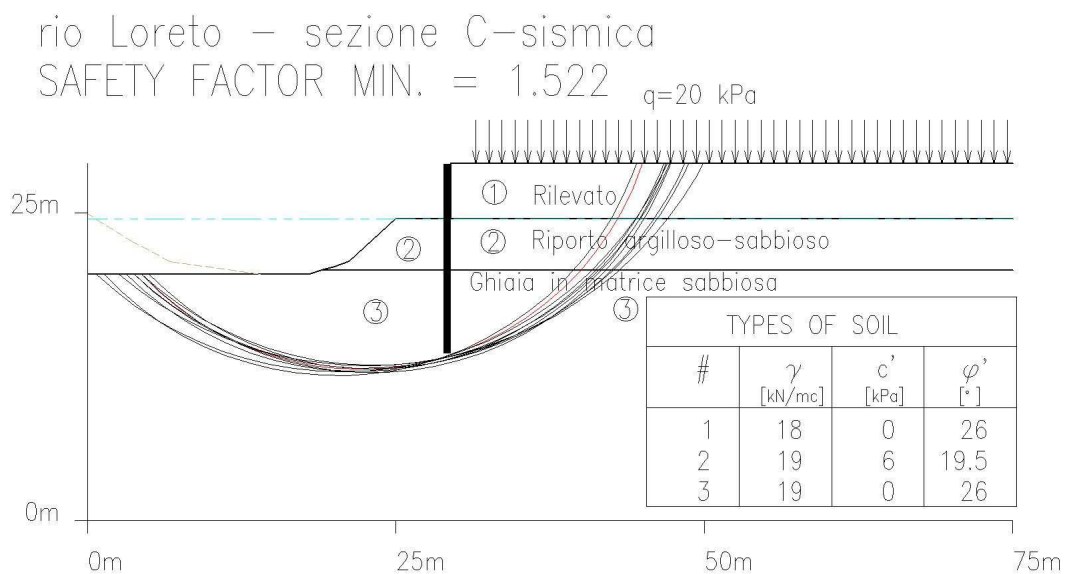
Rio Loreto Muro sezione C SVASO – verifica complesso muro terreno – verifica sismica
